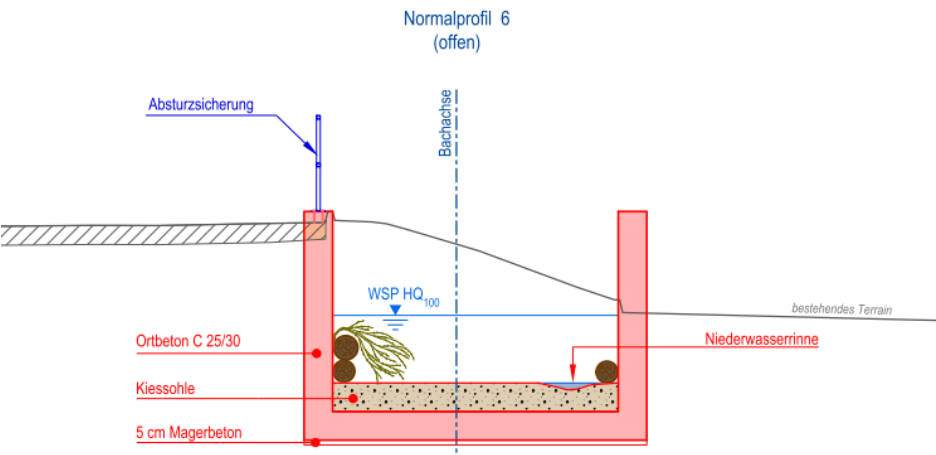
Gestaltung gemäss Normalprofil 6 (offener Betonkanal)
